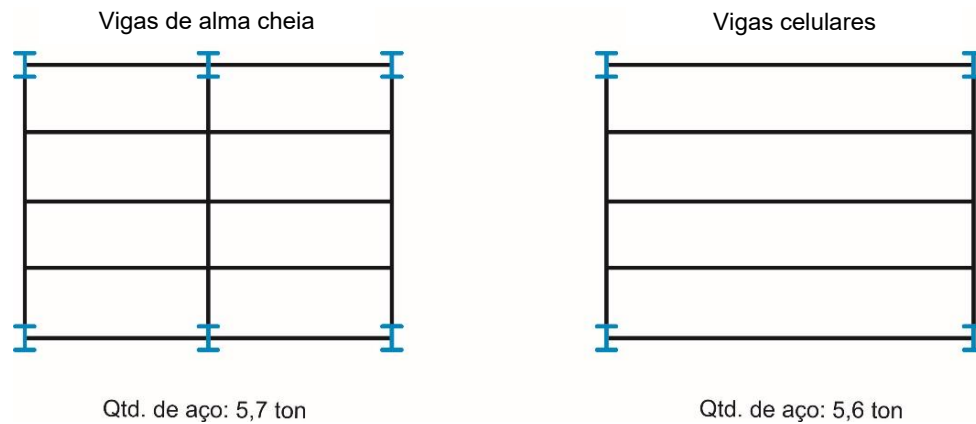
Comparação do consumo de aço entre pavimentos com vigas de alma cheia e com vigas celulares.
